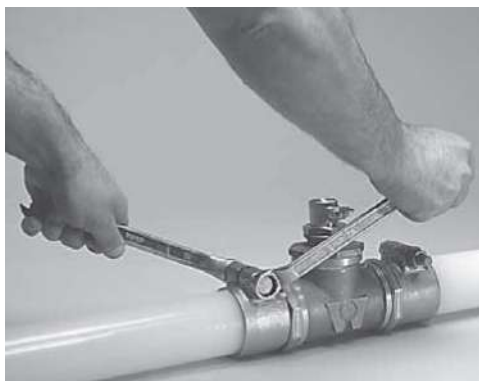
Zabezpečit šroub svorkami a sejmout upínací objímku ze spojky.
